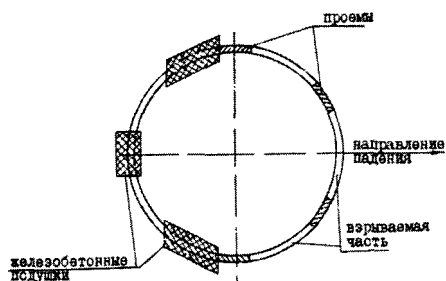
Повалка железобетонной трубы с устройством подушки отдельными секциями и последующим взрывом перемычек
